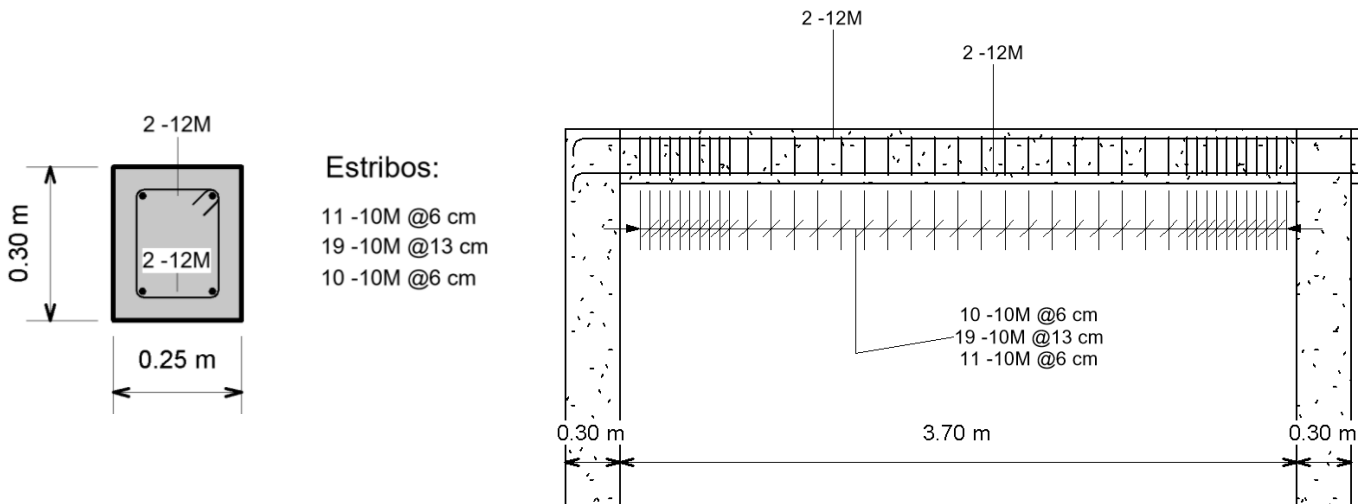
Dimensiones de la sección transversal y del refuerzo colocado en la viga 2 OMF del sistema de 3 pisos
